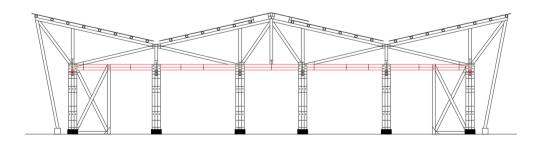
Secciones de Vigas en Vista Transversal. Fuente: [Propia]
